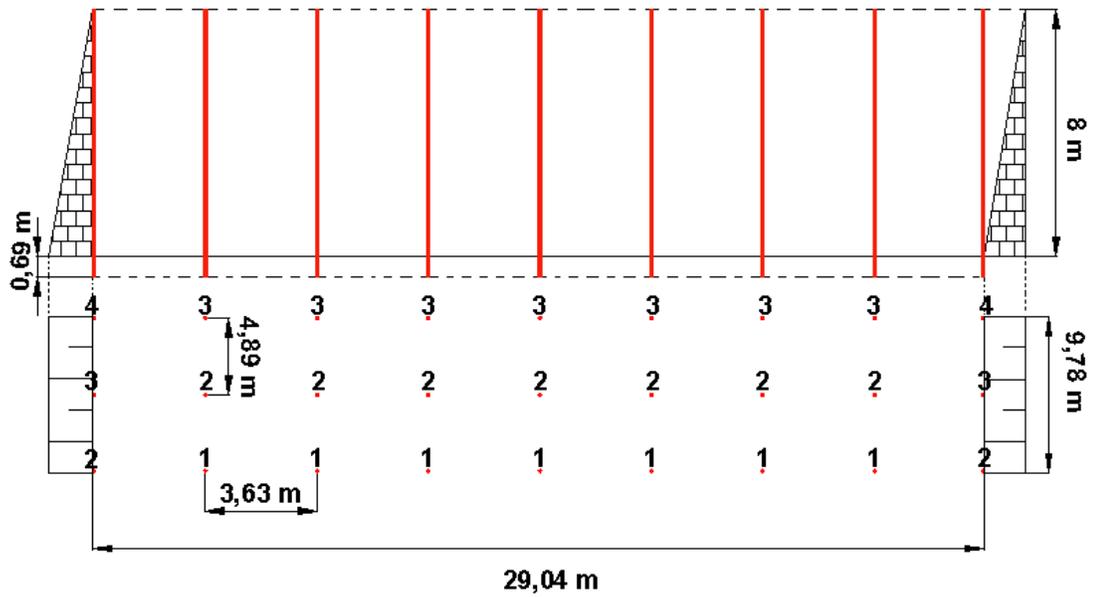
C. Perfil transversal y vista superior de la disposición de los taladros en el horizonte 1 (Bloque 13)
